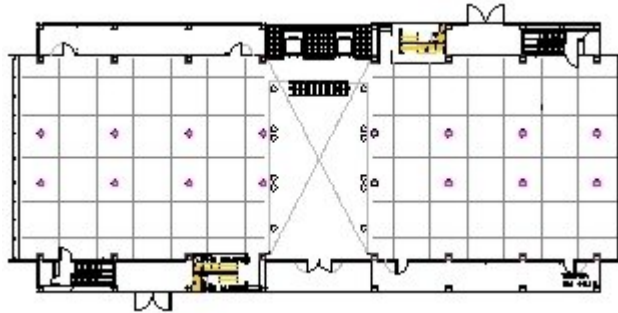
Plano del primer piso de oficinas de la torre de ingeniería.
